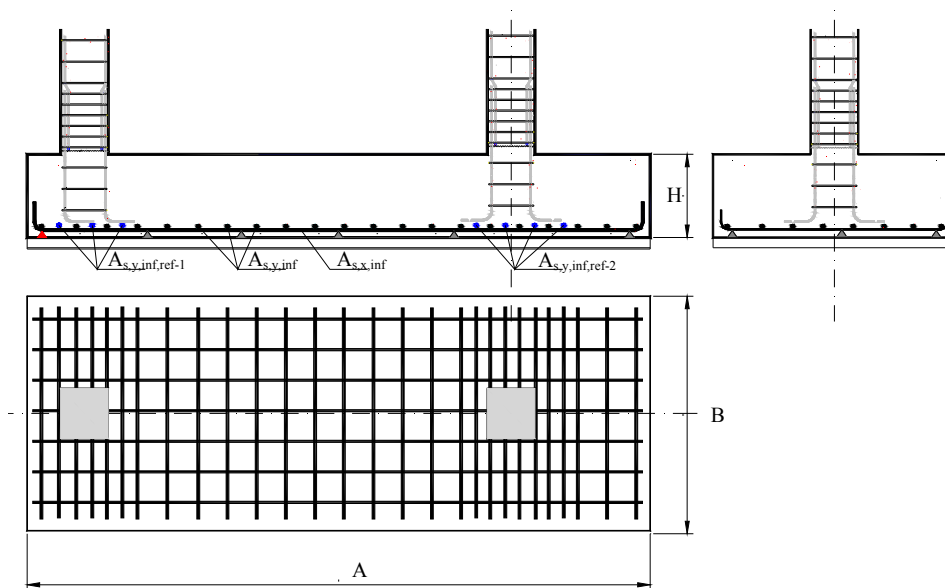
Modelo 5. Patrón de armado. (Configuración 1).
